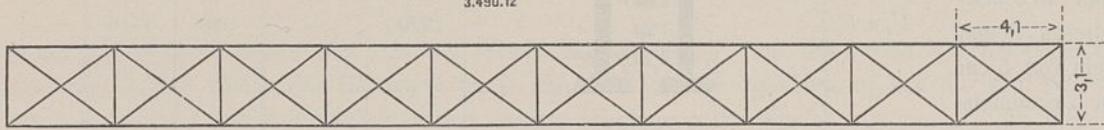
Grundriß des Windverbandes eines Überbaues.
